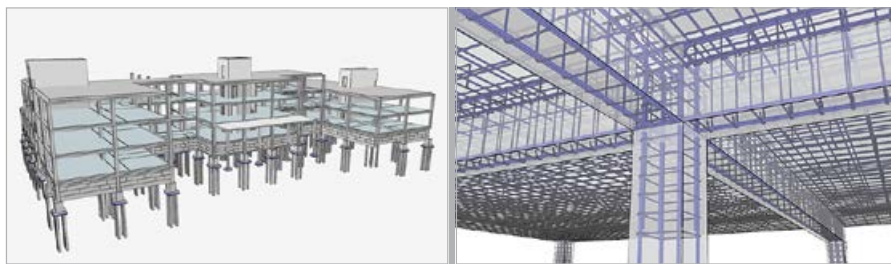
Железобетонный каркас здания и армирование несущих элементов каркаса
